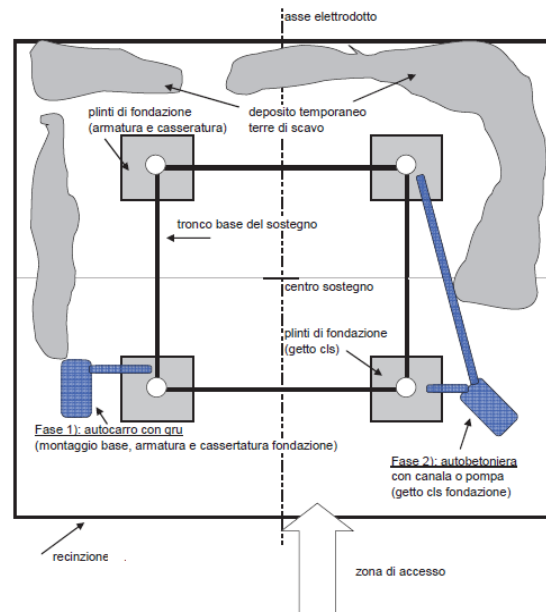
Planimetria tipologica del microcantiere nella fase di getto per la realizzazione dei plinti di fondazione
